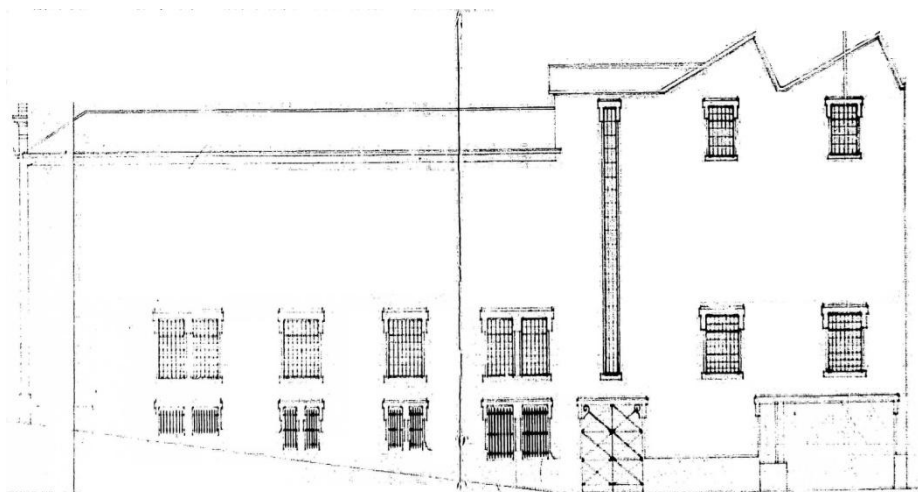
Fachada inicial sobre a Rua da Frente
